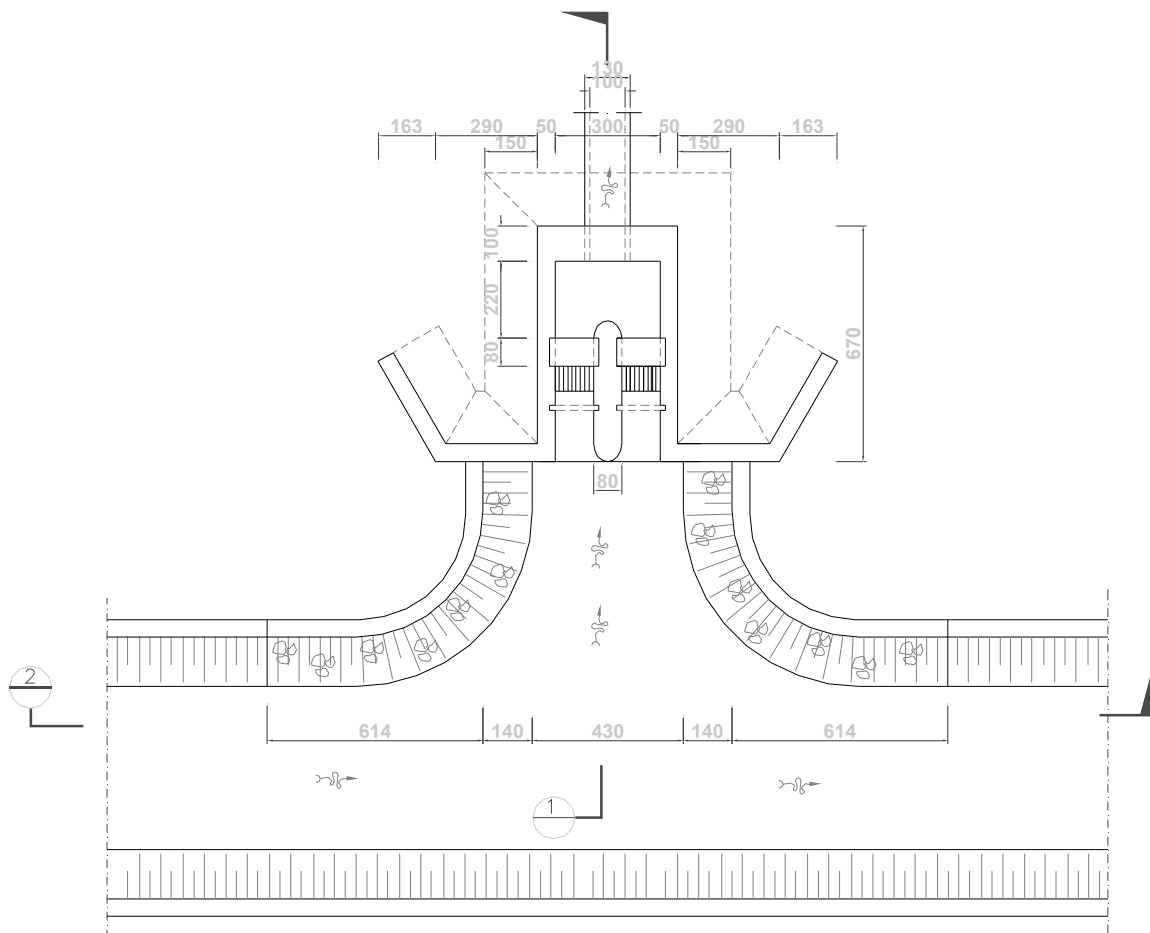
Potongan 4 bangunan pengambilan bebas dengan pintu air
